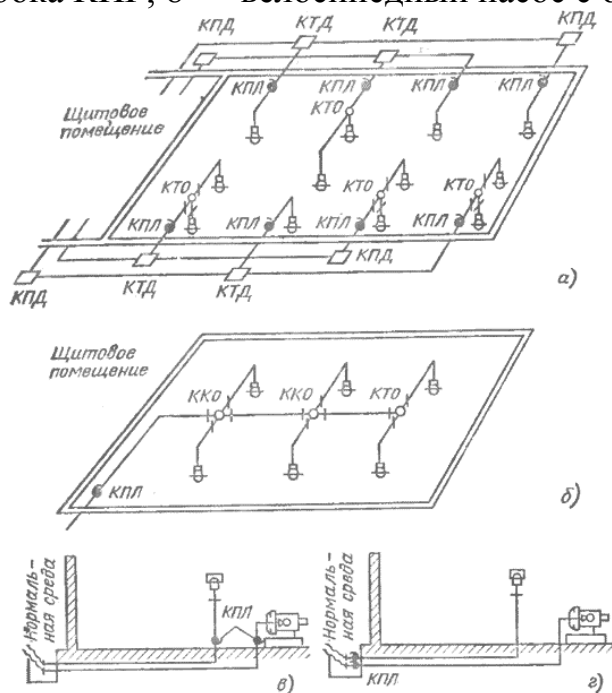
Примеры выполнения осветительных и силовых электропроводок в стальных трубах во взрывоопасных зонах:
